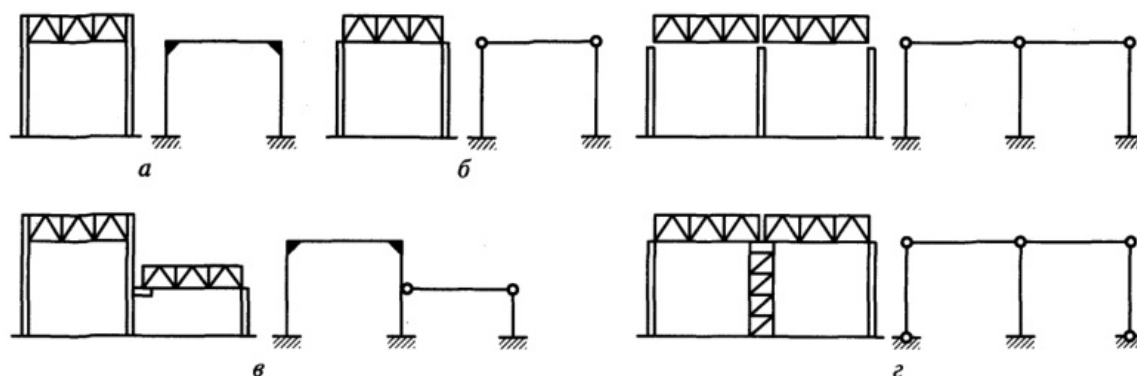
Виды сопряжения ригеля с колонной и расчетные схемы поперечных рам:
